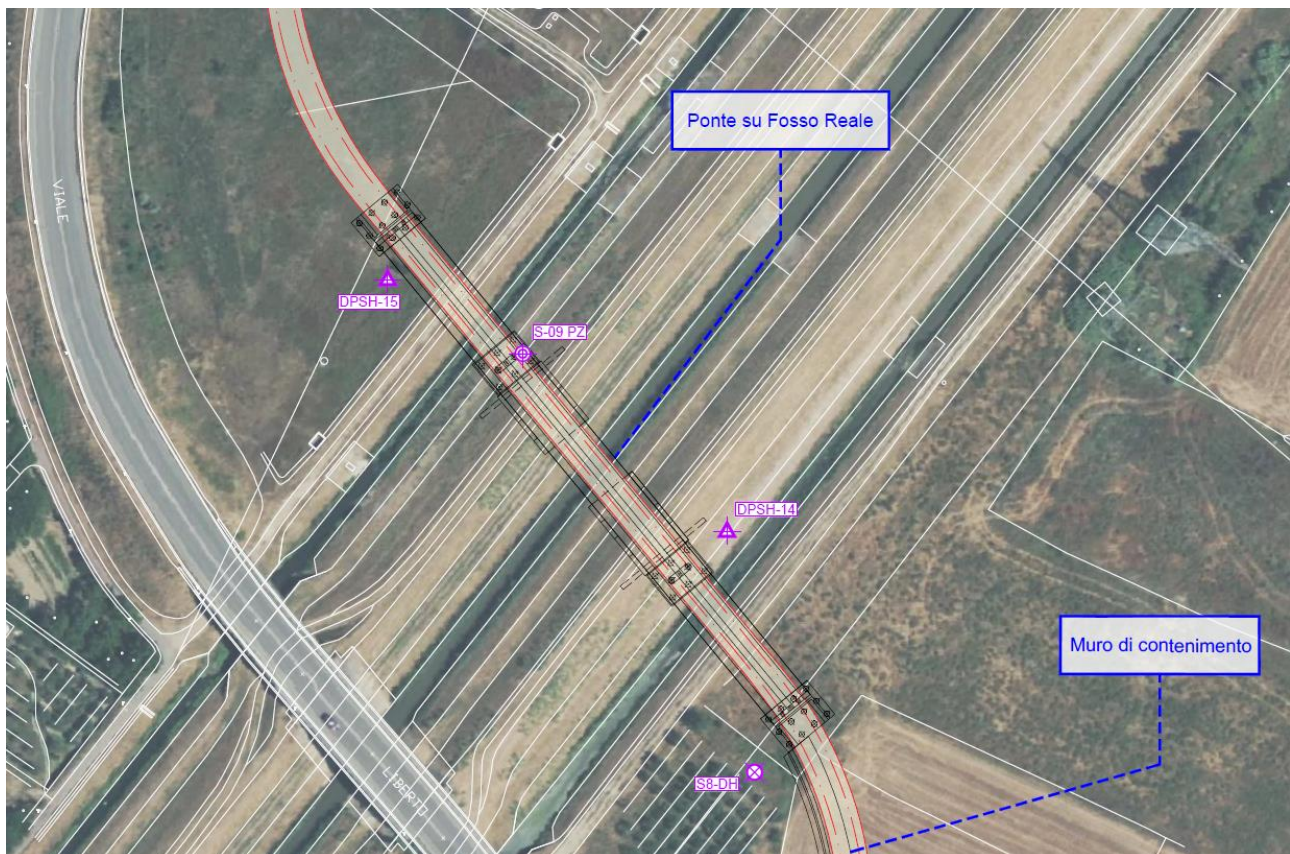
INDIVIDUAZIONE PLANIMETRICA DEL NUOVO PONTE SUL FOSSO REALE
